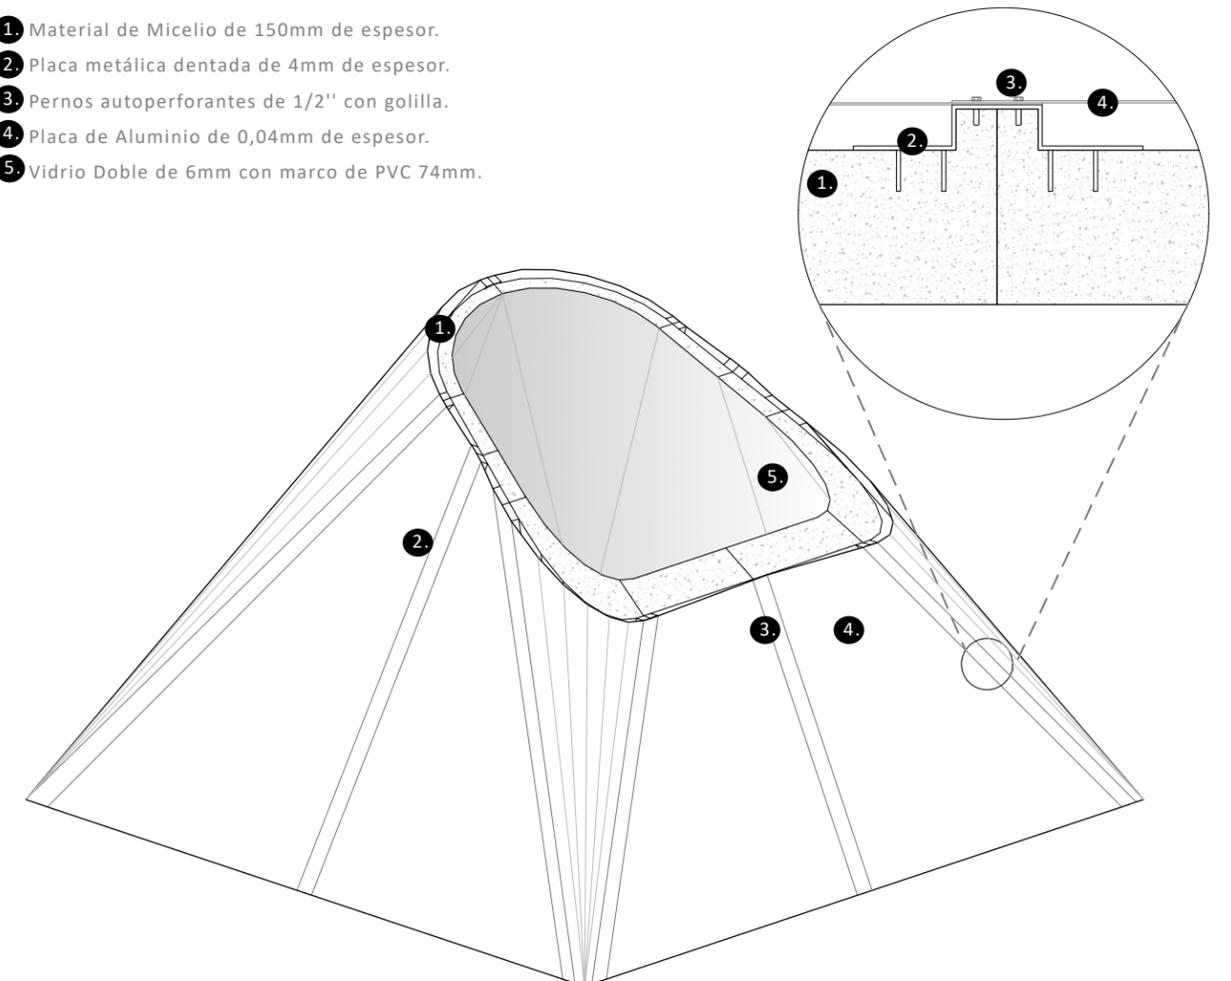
Isométrica con detalle del componente constructivo. Elaboración propia.
